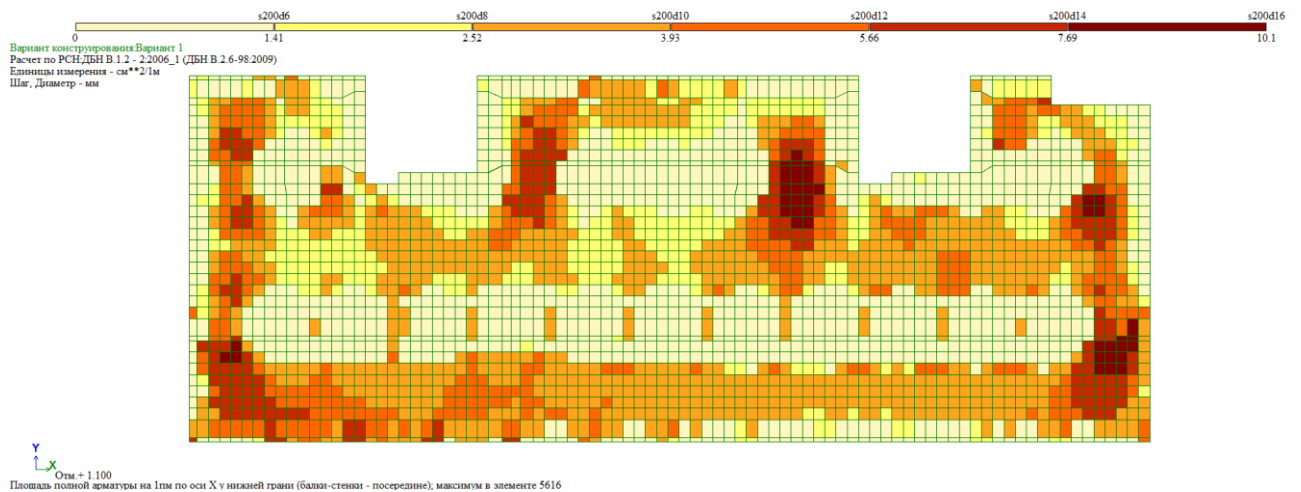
Розрахункове армування нижньої грані плити перекриття на відм. +1,100 вздовж осі X від основних сполучень навантажень
